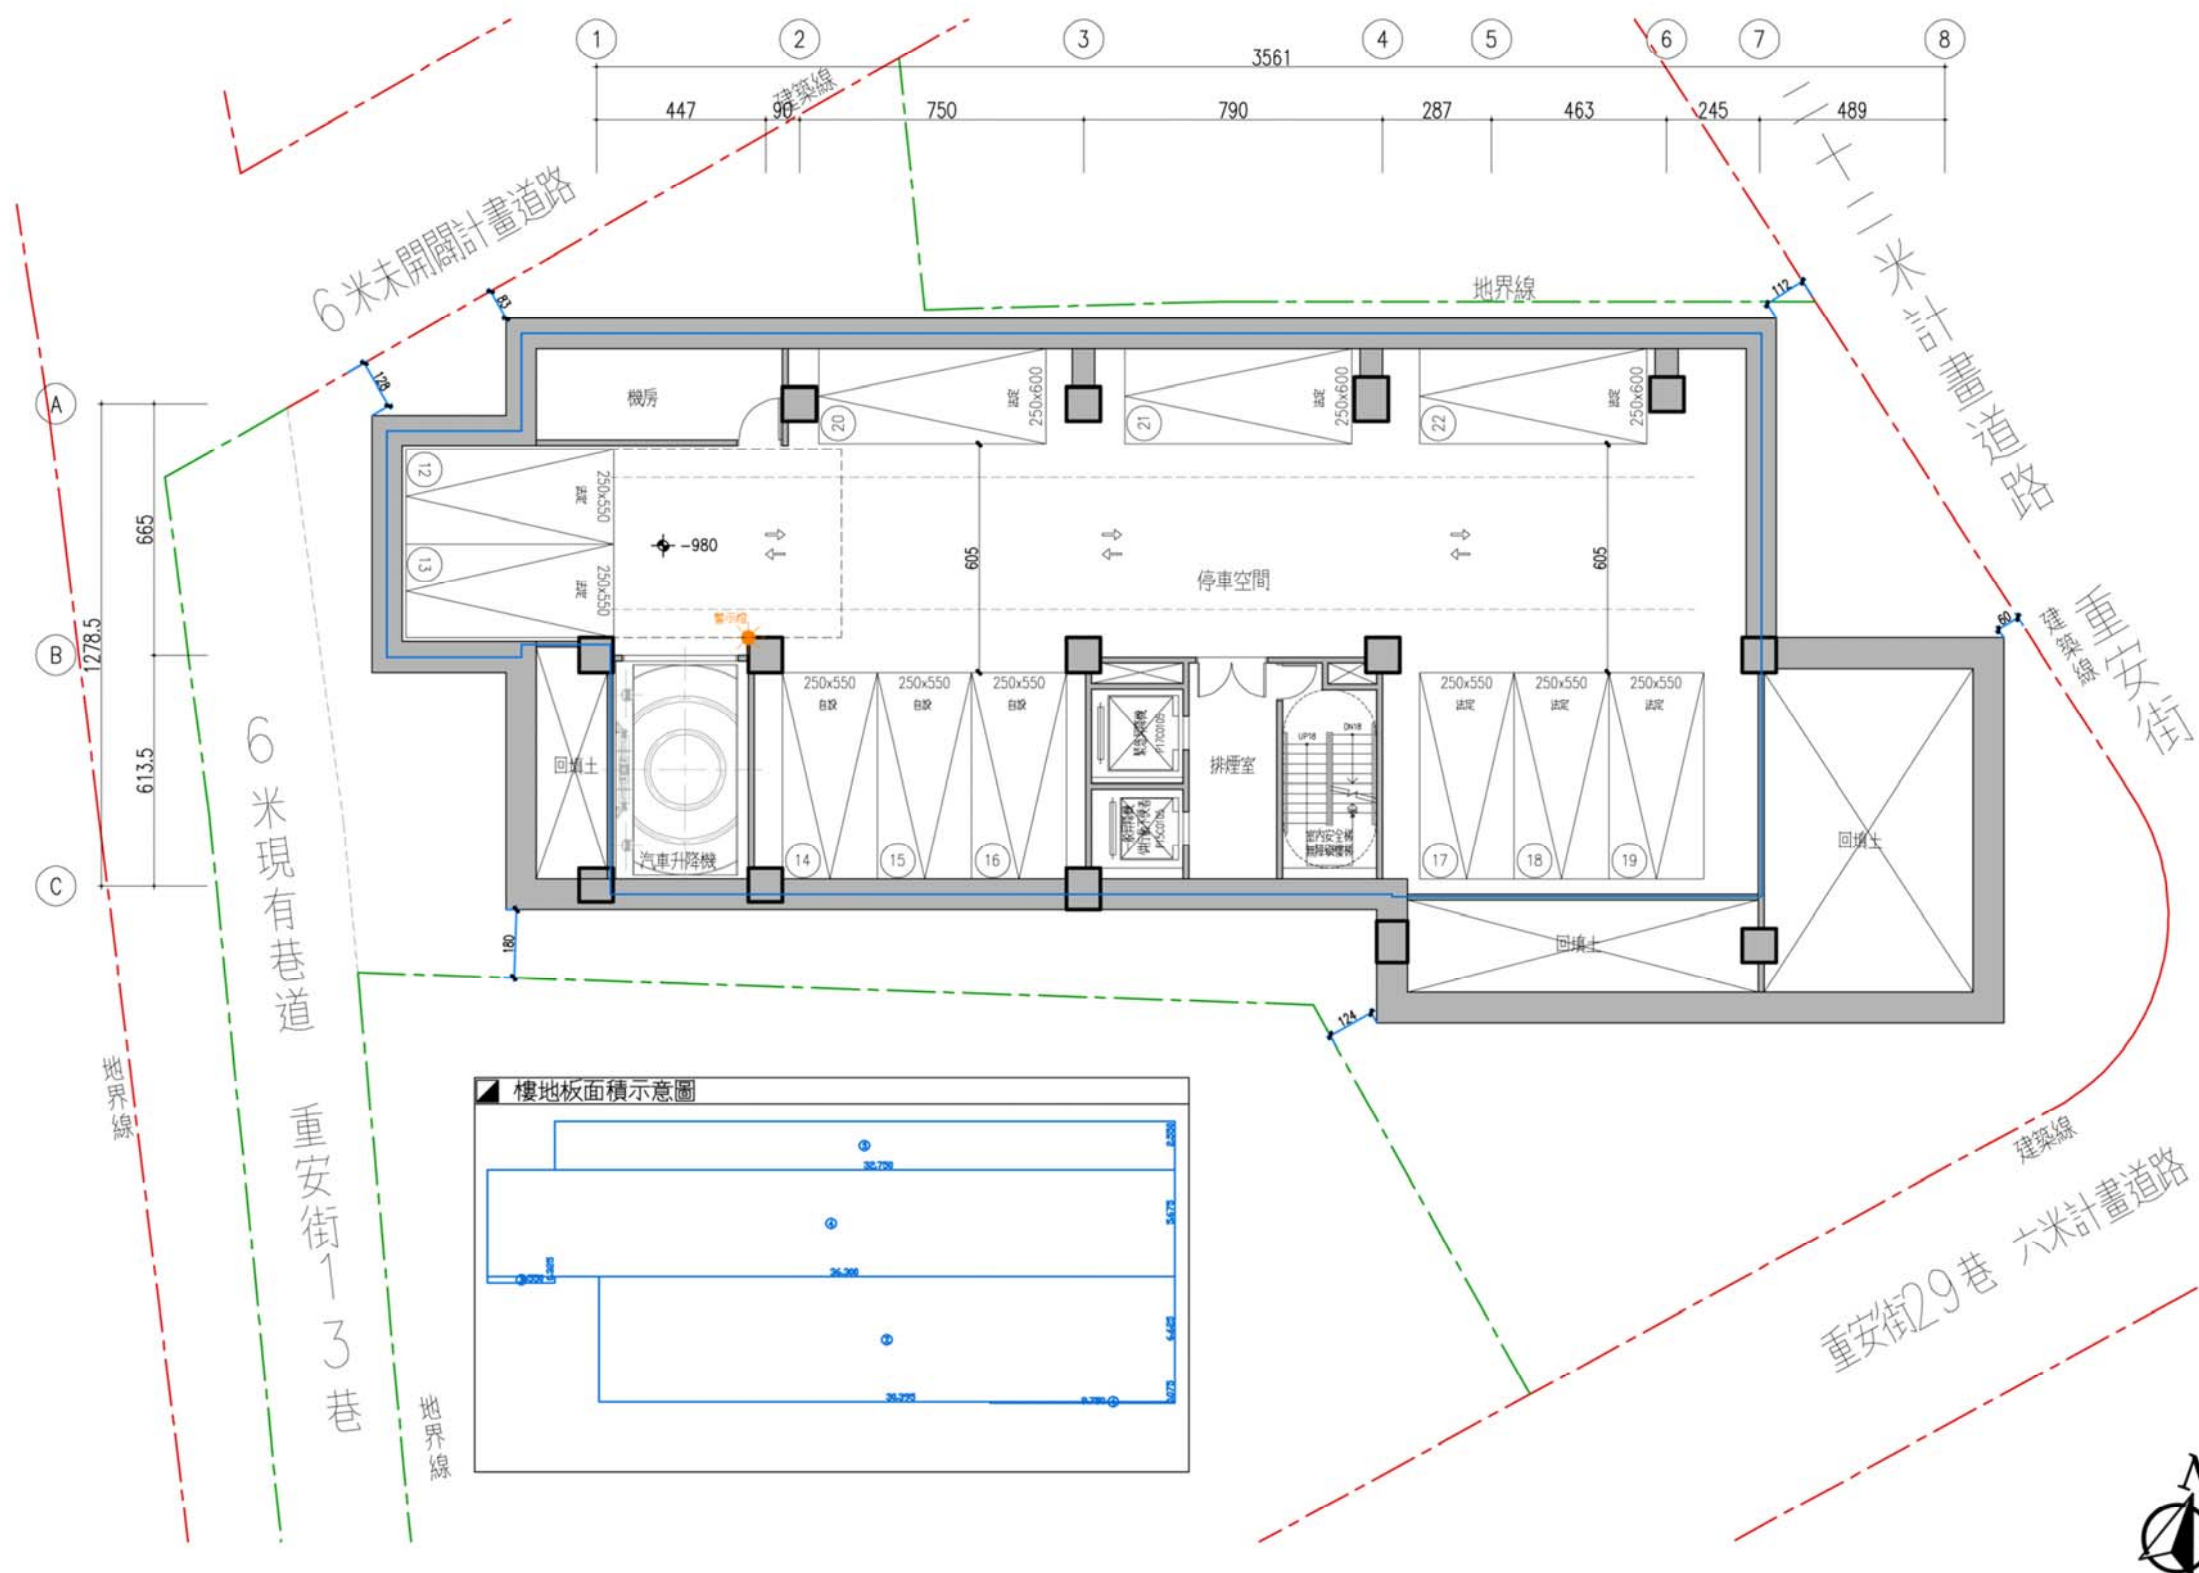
地下三層平面及面積計算圖(S=1/200)
